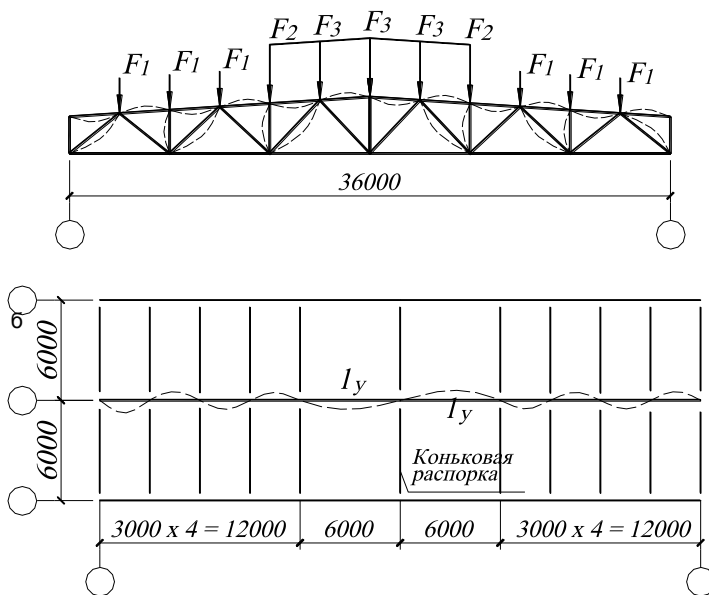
Схема приложения нагрузки к узлам стропильной фермы. Схема деформирования сжатых элементов:
